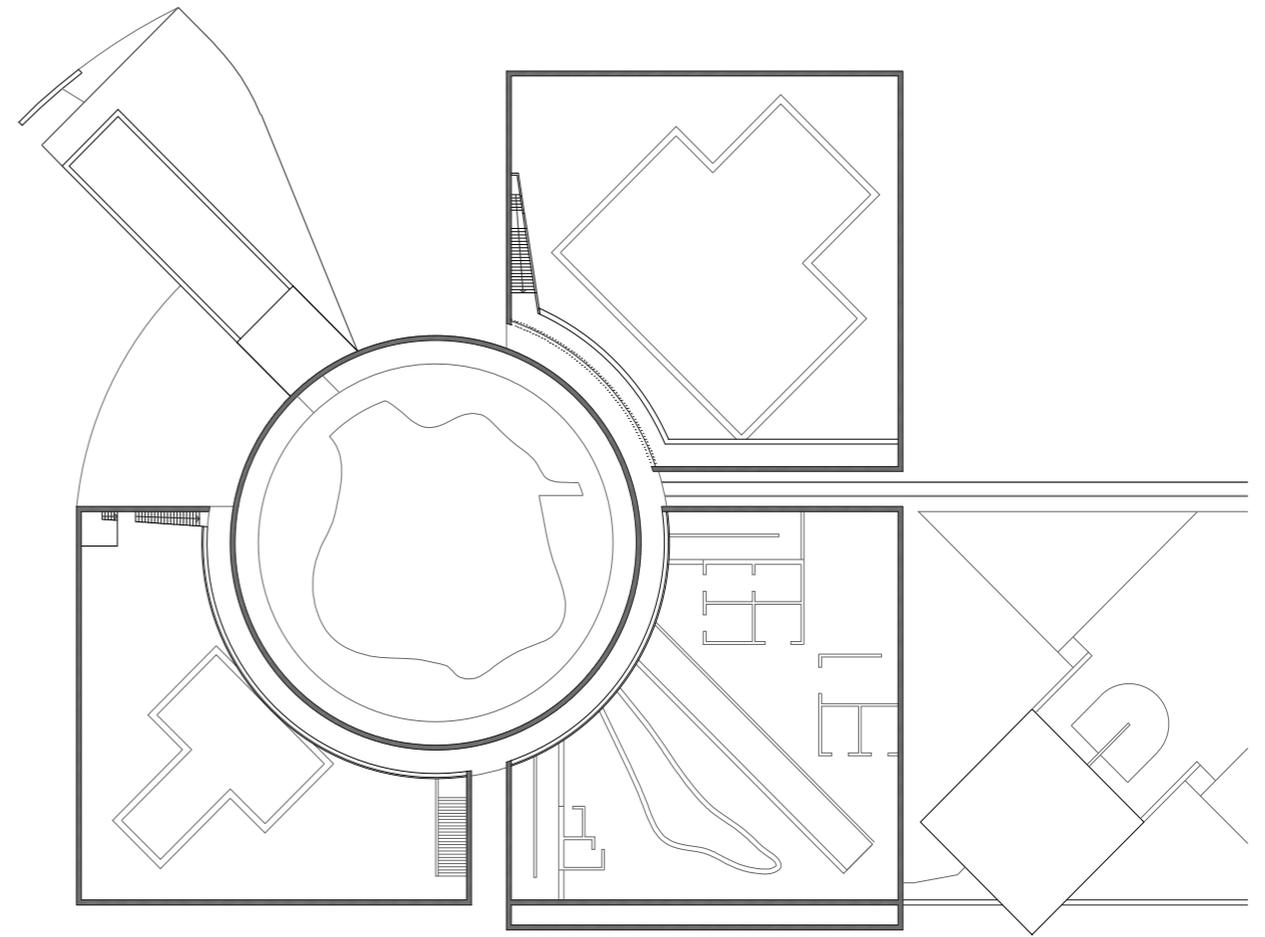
Axonometría seccionada a nivel de la galería perimetral.
